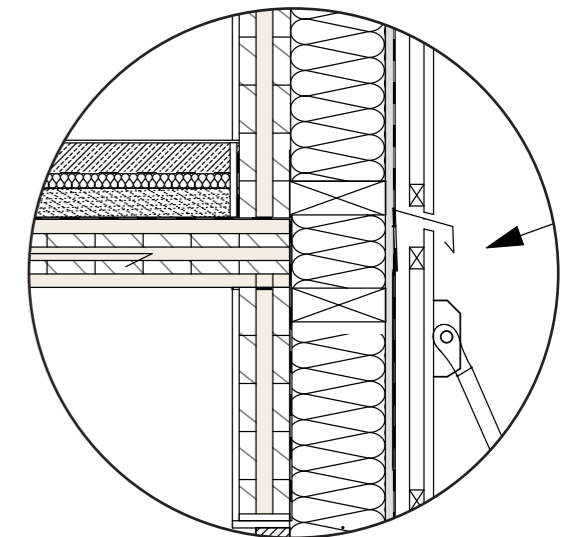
Detail Blechschürze hinterlüftete Fassade
